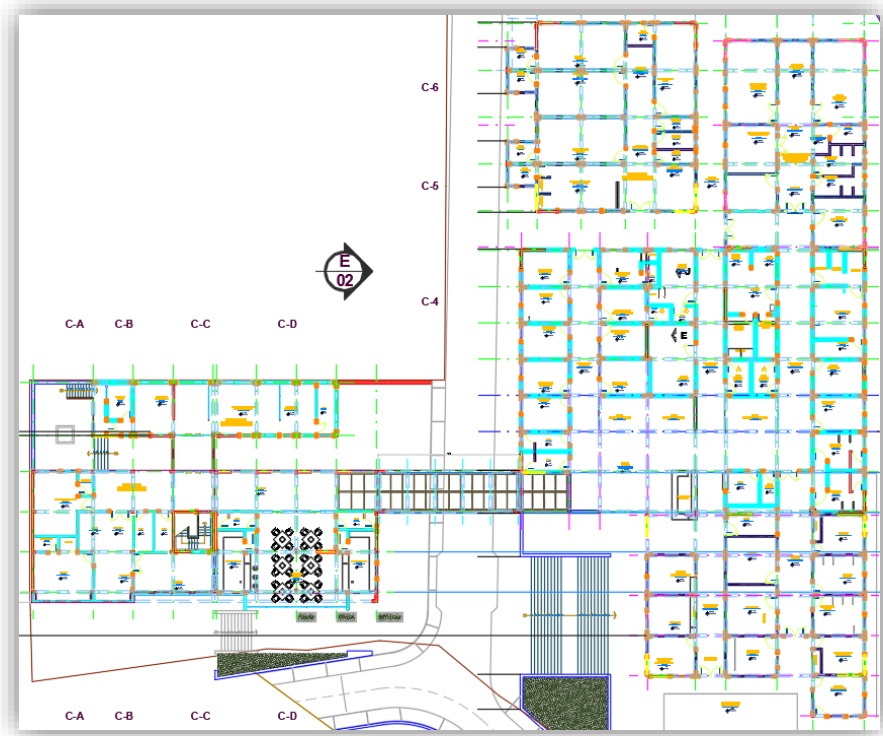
Plano de planteamiento general, comprende los 8 bloques y las obras exteriores
